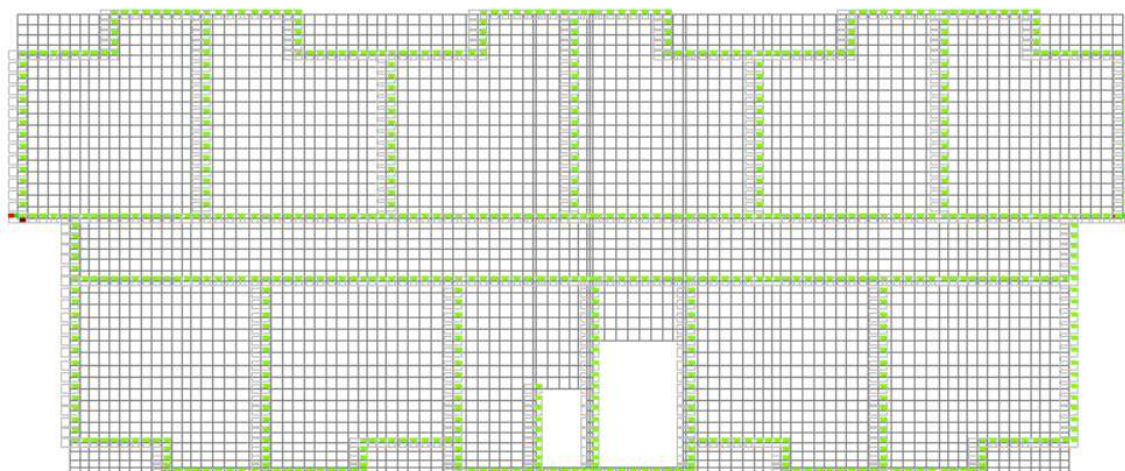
Расчётная схема плиты перекрытия в плоскости
